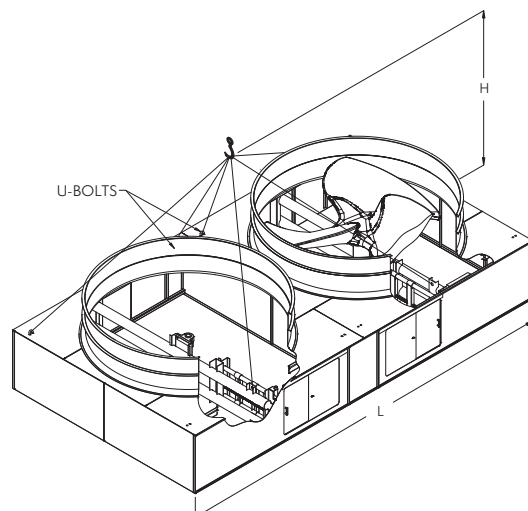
Sezione ventilante 14' x 26' con sei punti di sollevamento
